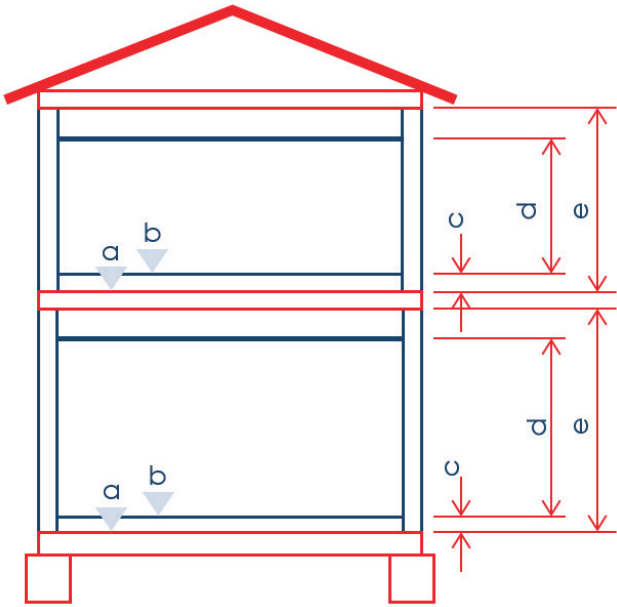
Figura basada en la figura 183, Space Elevations elaborada por buildingSMART International.
